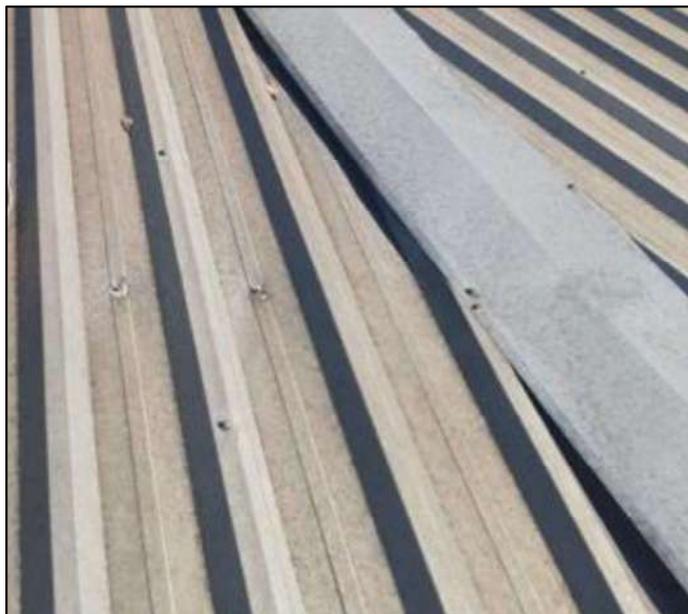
Fixação inadequada das telhas trapezoidais tipo “sanduiche”
